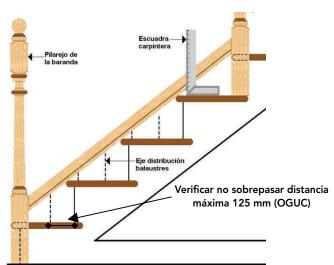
36: Armado de la baranda de la escalera. Se puede observar la colocación de los pilarejos y la presentación y forma de atraque del zócalo.
